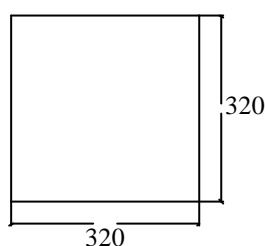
Representação das condições de apoio da laje de tampa para o reservatório elevado (dimensões em cm).
